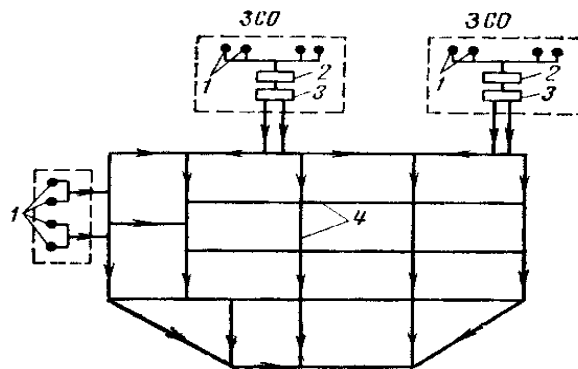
Схема водопровода с трехсторонним питанием:
